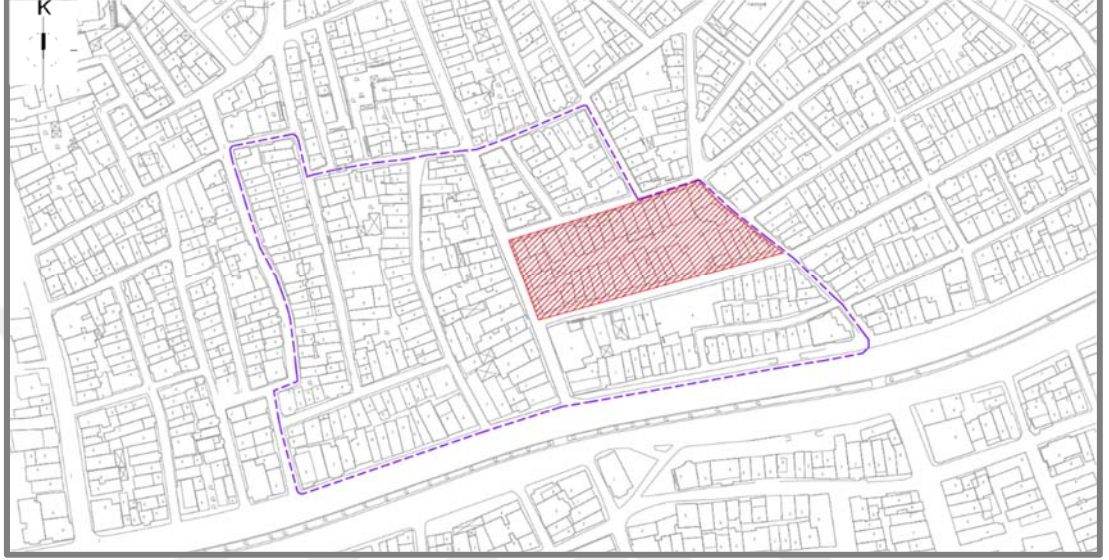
361-B ada 2007 onaylı avan projenin vaziyet planı [4]
